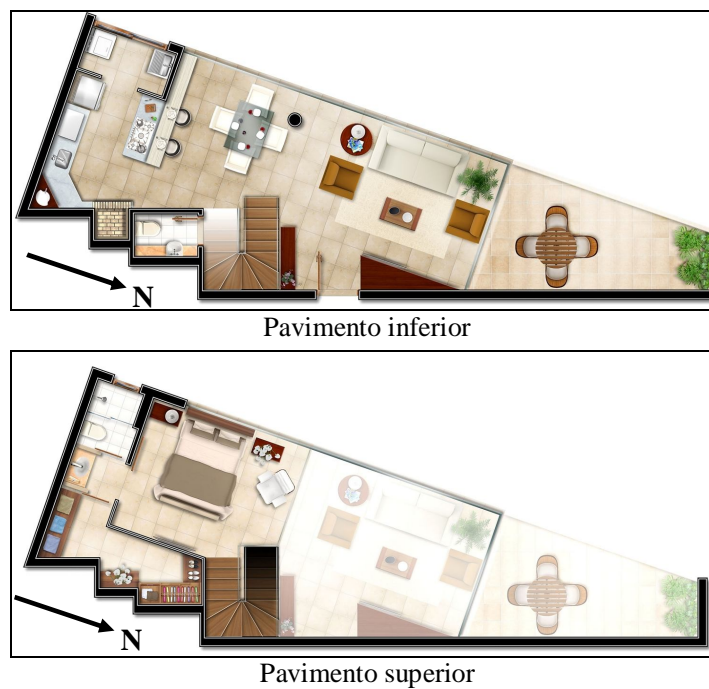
Planta baixa ilustrativa do pavimento inferior e superior da tipologia 04 (gf15)
